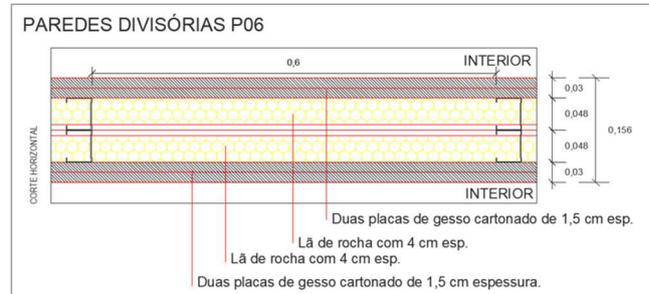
Divergência entre lista de quantidades e pormenor construtivo
